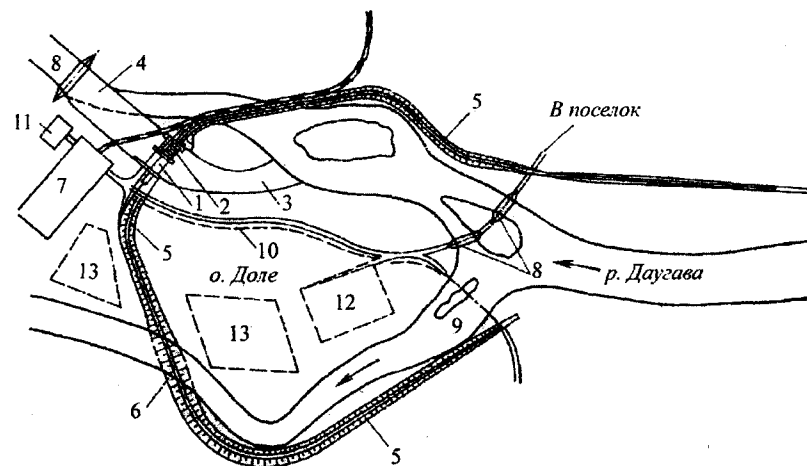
Схема перекрытия р. Даугавы на Рижской ГЭС: 1 – здание ГЭС, 2 – водосливная плотина, 3 – подводный канал, 4 – отводящий канал, 5 – береговые плотины, 6 – русловая намывная плотина, 7 – производственная база строительства, 8 – перемычка, 9 – створ банкета для перекрытия русла реки, 10 – дамба обвалования для пуска 1-го агрегата, 11 – резерв камня, 12 – карьер гравийной массы, 13 – карьер песка для гидромеханизации
